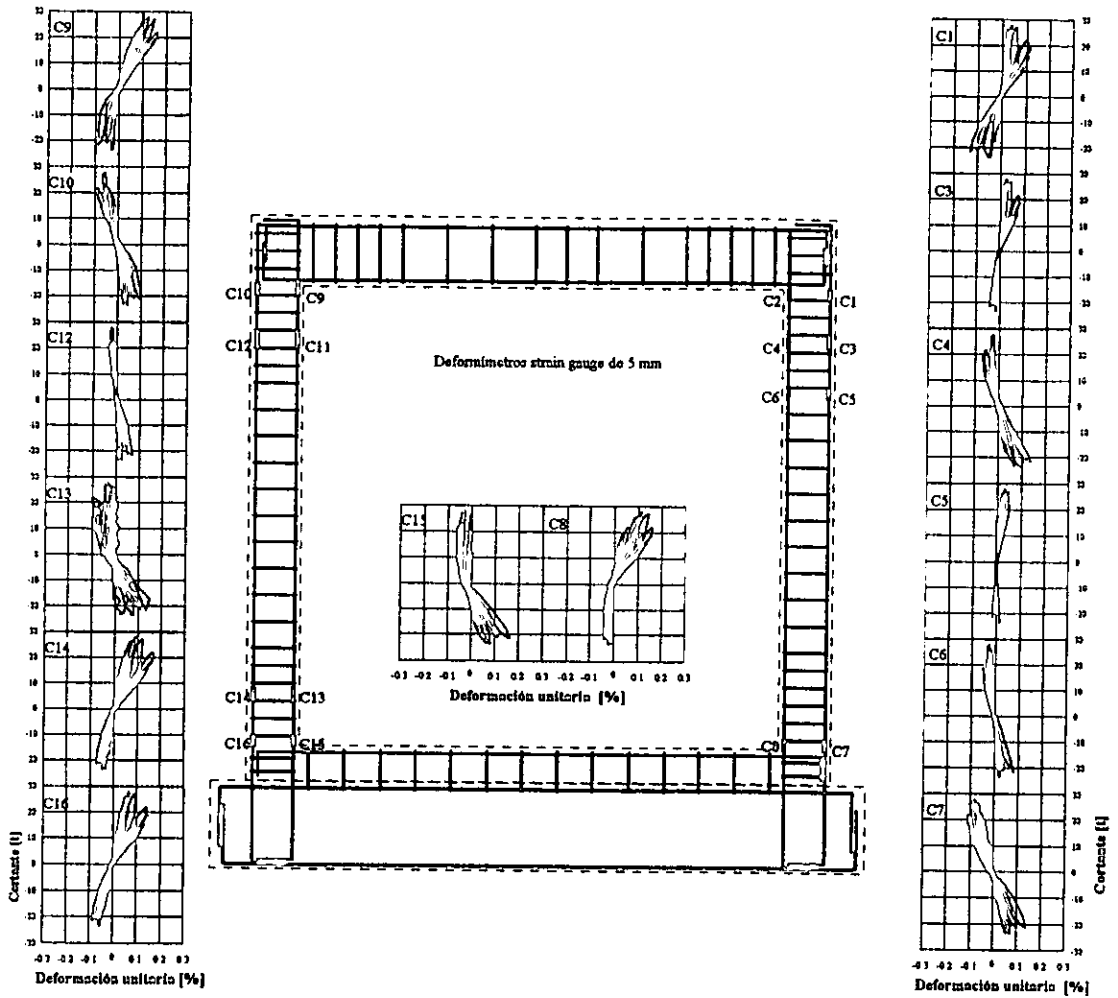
Deformímetros ubicados en el acero longitudinal de las columnas
